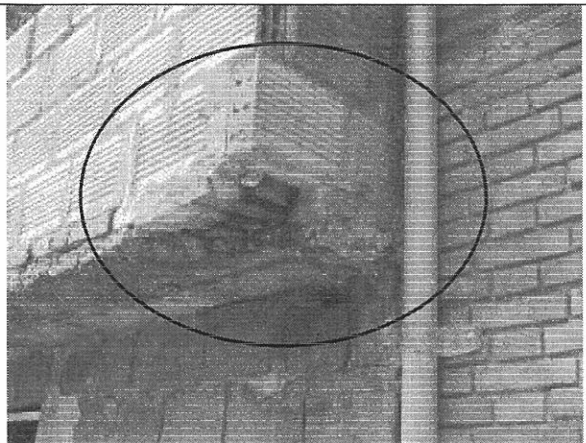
Placa en voladizo de la parte posterior en malas condiciones.
